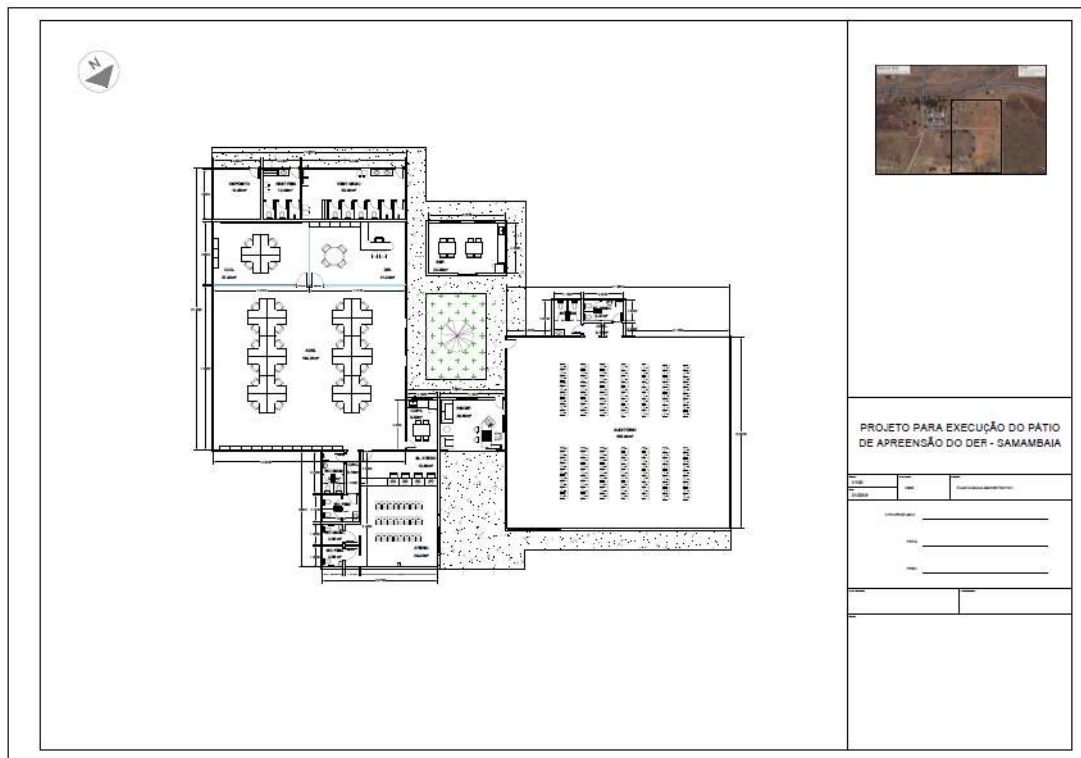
Planta baixa do Prédio ADM do Pátio Samambaia (Fonte: Elaboração própria)
